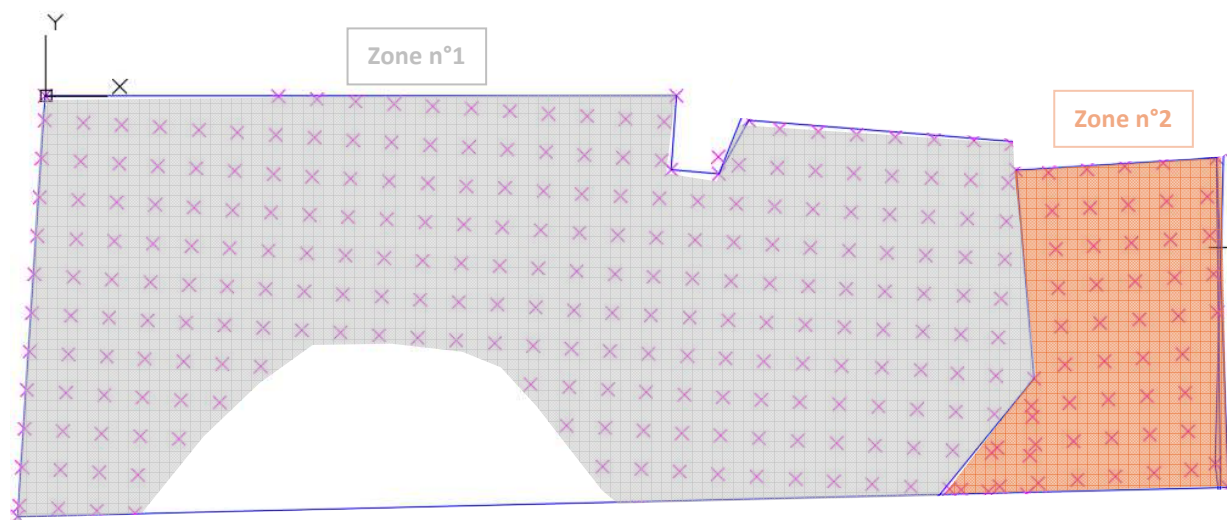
Zone de mesures entre la façade avant et l'aile Nord
